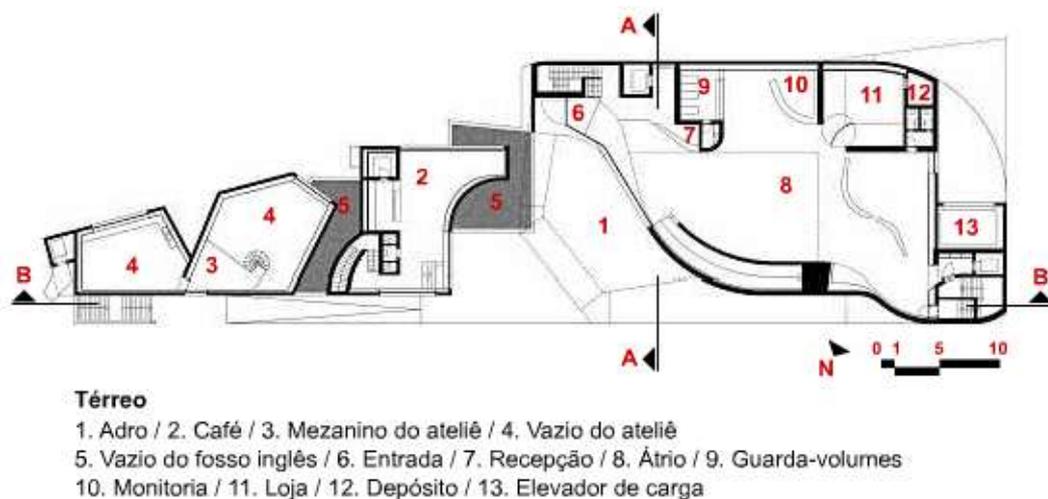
Planta baixa do pavimento térreo do museu (Fonte: ARCOWEB, 2011)
